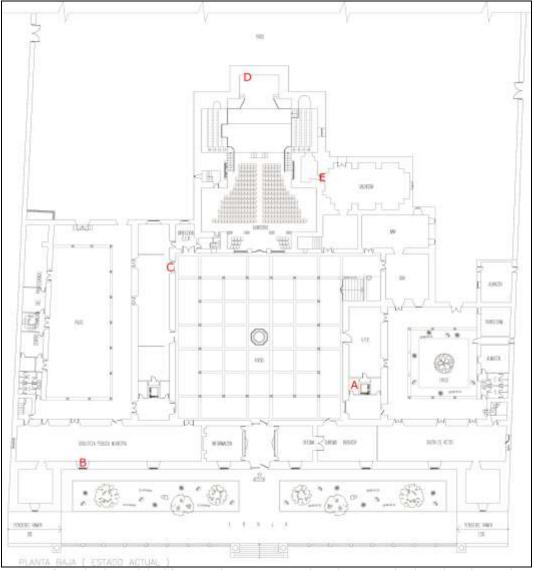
Plano de planta del edificio. Las letras en rojo indican las zonas donde se han detectado factores biológicos de alteración.
